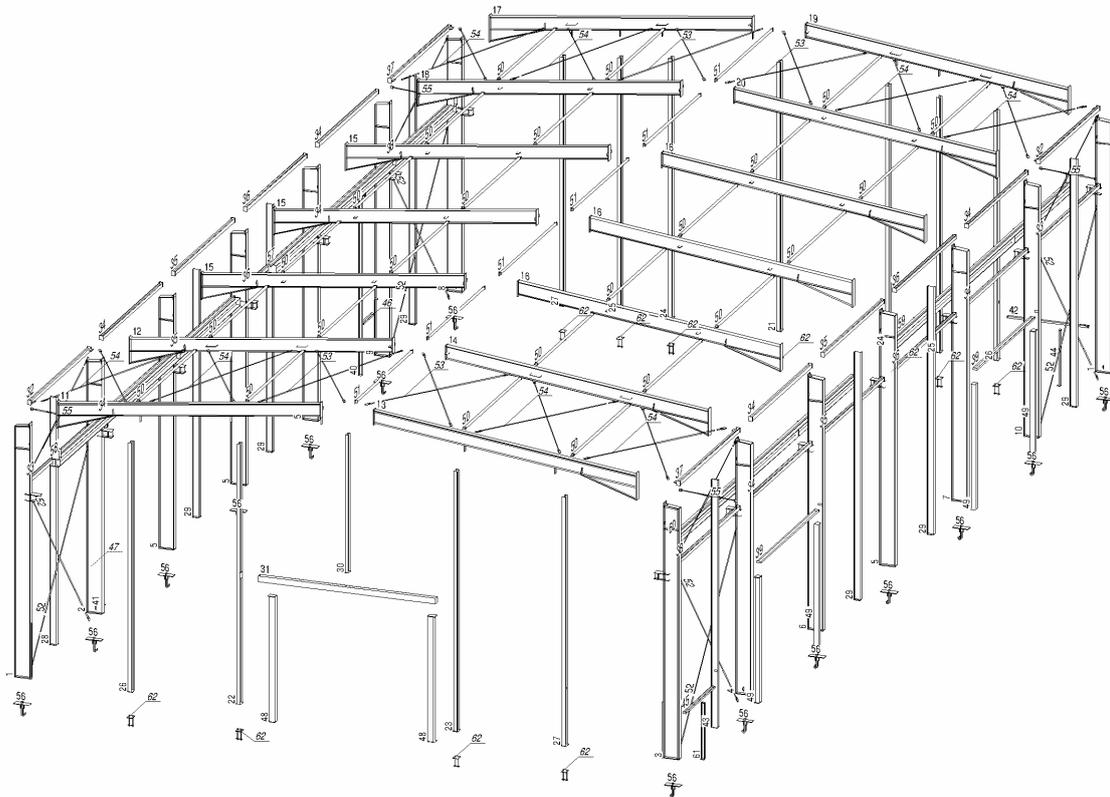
Explosionszeichnung zur Unterstützung der Montage
